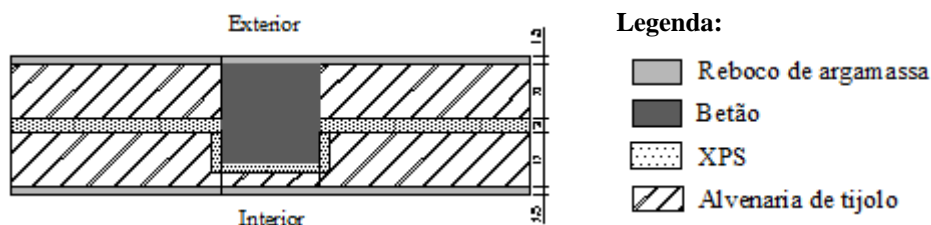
Pormenor construtivo do pilar na parede em contacto com edifício adjacente revestido com XPS
